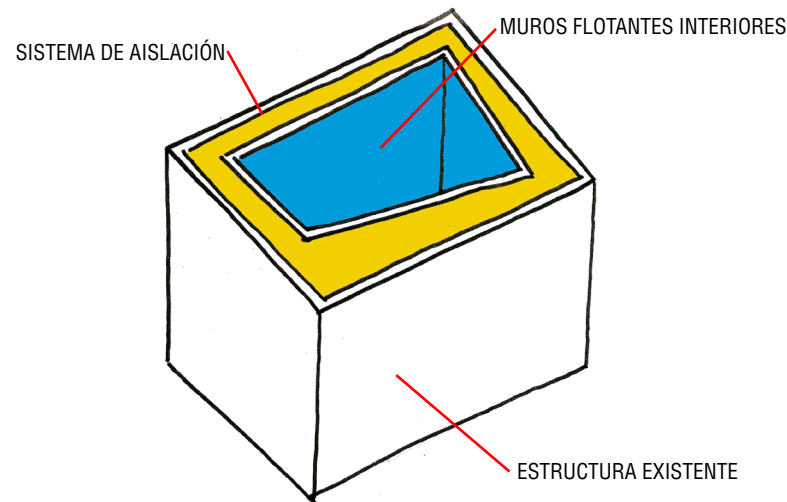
Esquema sistema constructivo Box Within Box. Fuente: elaboración del autor.
